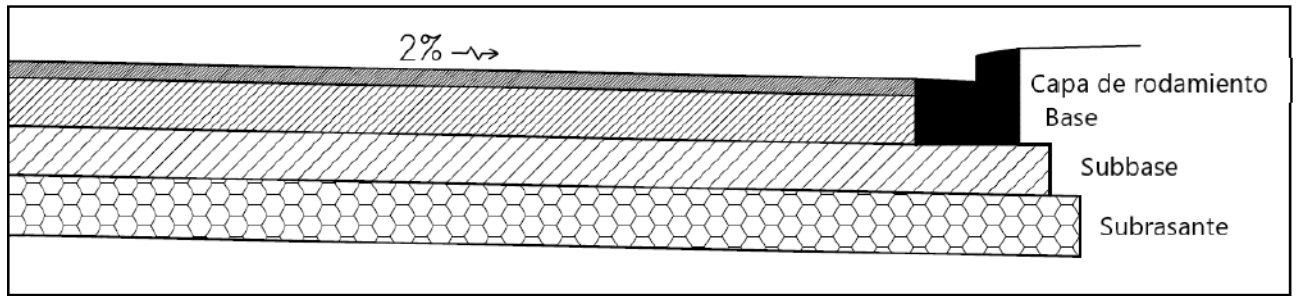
Croquis de paquete estructural Avenida N° 1 y Calle N° 2
